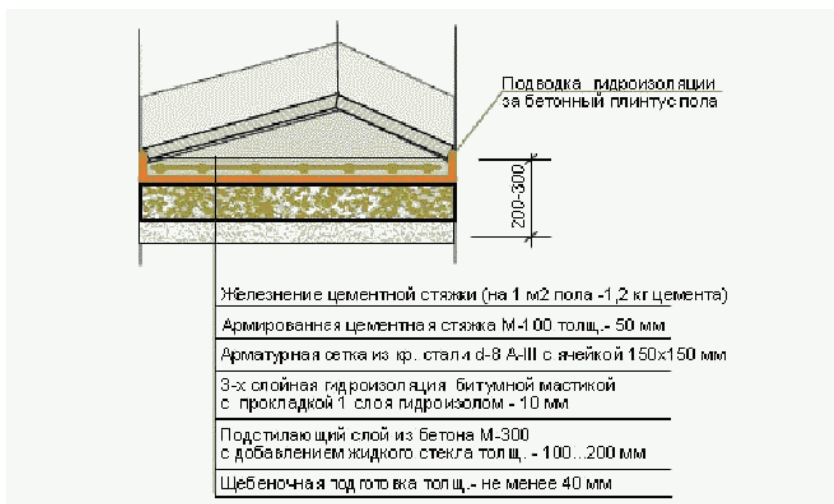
Гидроизоляция пола подвала. Защитная стяжка по слою бетона на полу подвала
